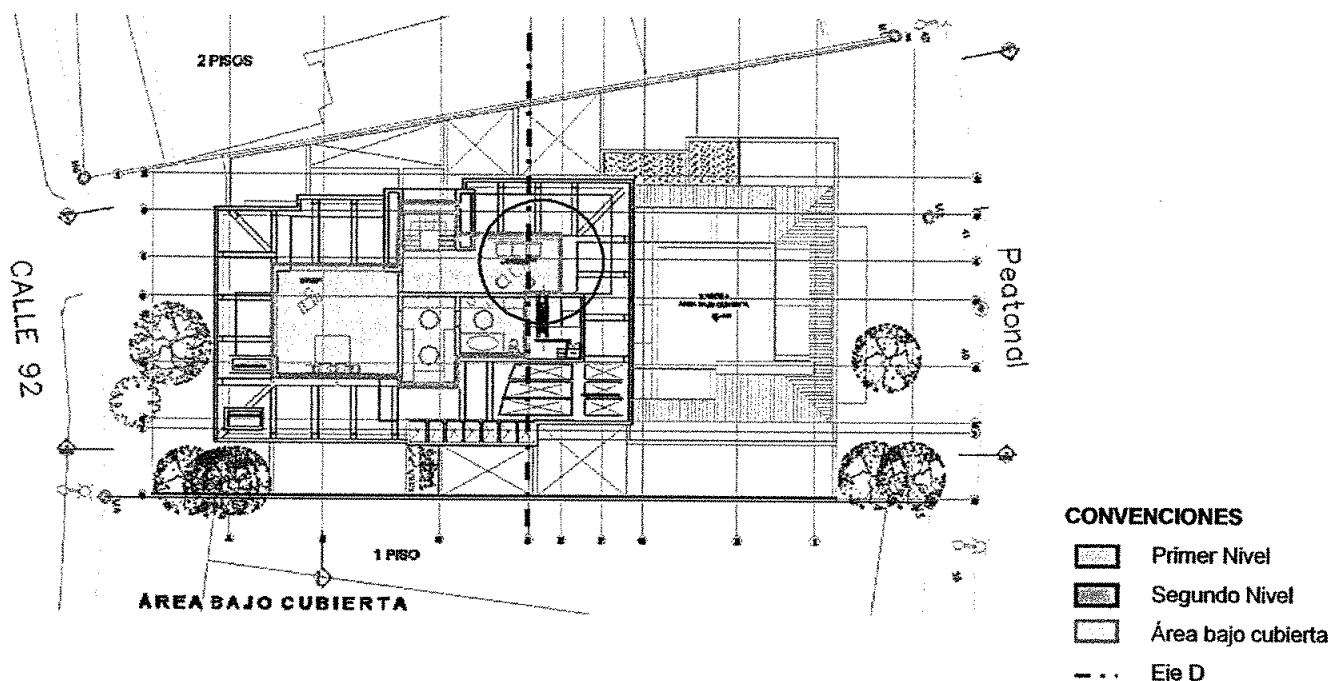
Áreas habitables por planta según la modificación del proyecto, avalada en 2007
